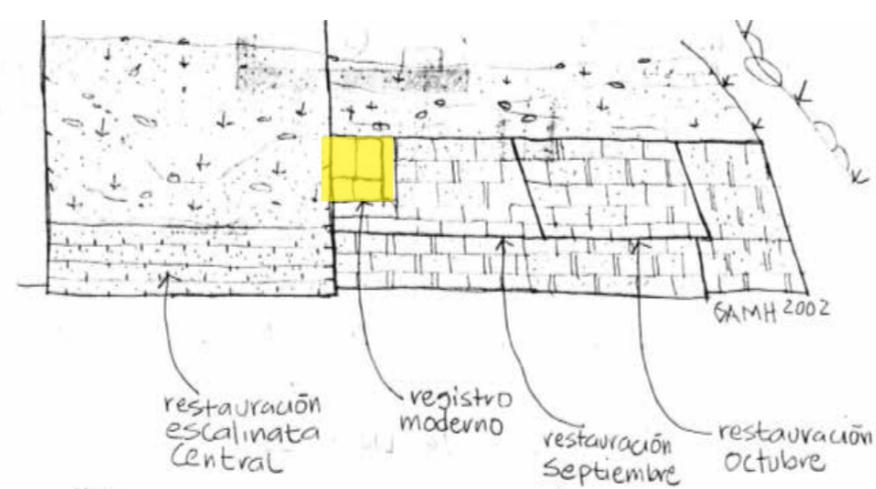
Dibujo Edificio 1. Fachada Este, primer cuerpo, lado norte. Detalle del estilo arquitectónico. Dibujo: GAMH 2002
